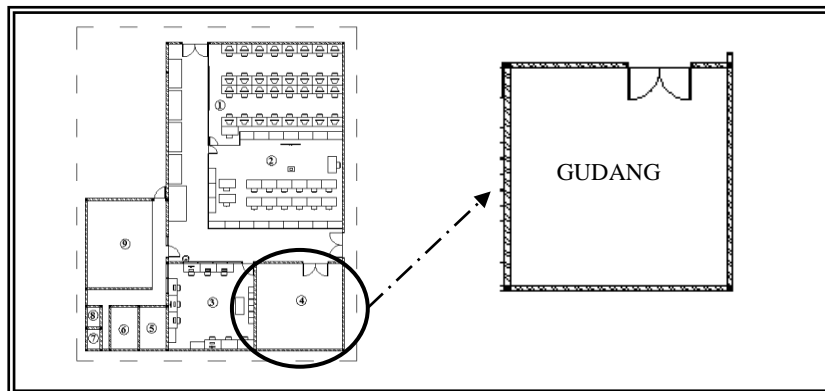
Lay Out Ruang Penyimpanan dan Instruktur
